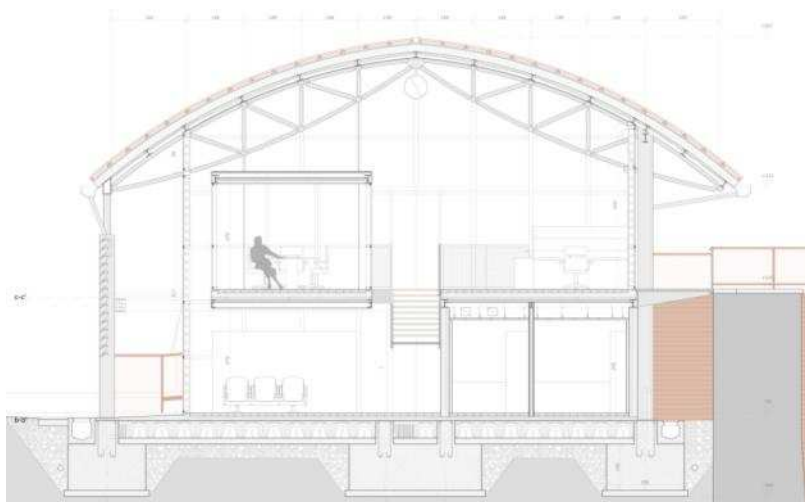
Sezione trasversale dell'edificio di progetto; in evidenza gli elementi strutturali e la trave reticolare a vista.
